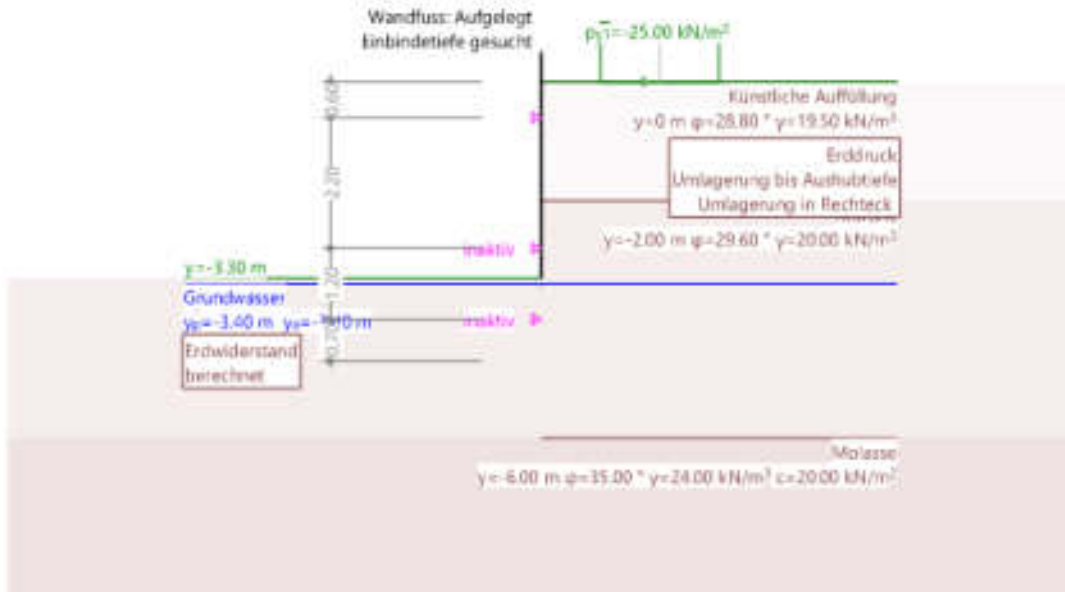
Baugrube vor Einbau 2. Spriesslage
